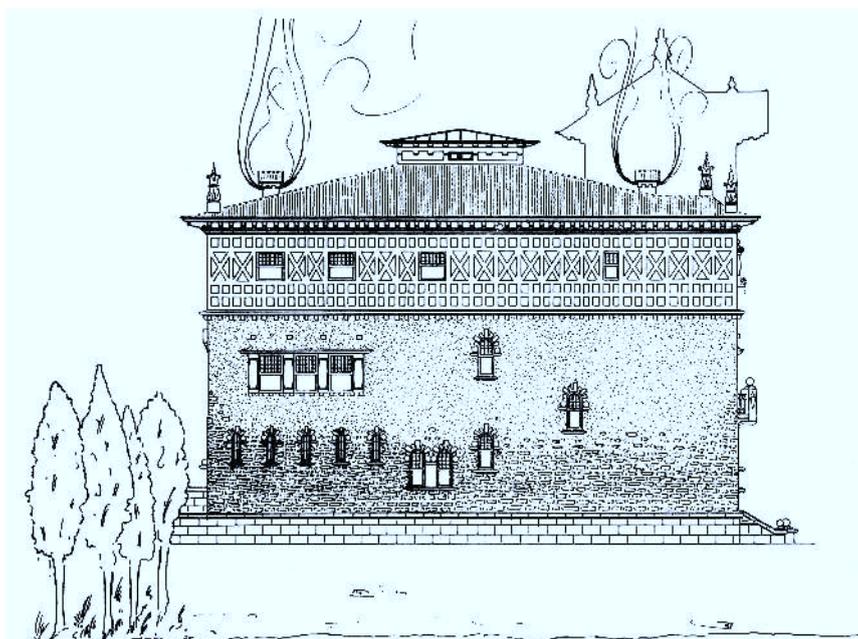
Proyecto para el Ayuntamiento de Carranza realizado en 1924 por el arquitecto Julio Sáenz de Barés. Alzado de la fachada lateral izquierda. (Edificio no construido).
